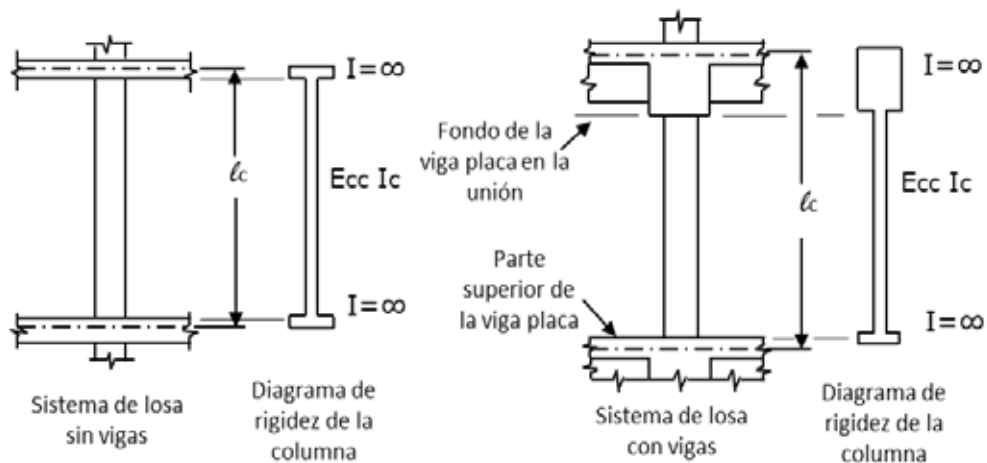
Secciones para calcular la rigidez de las columnas, K_c
